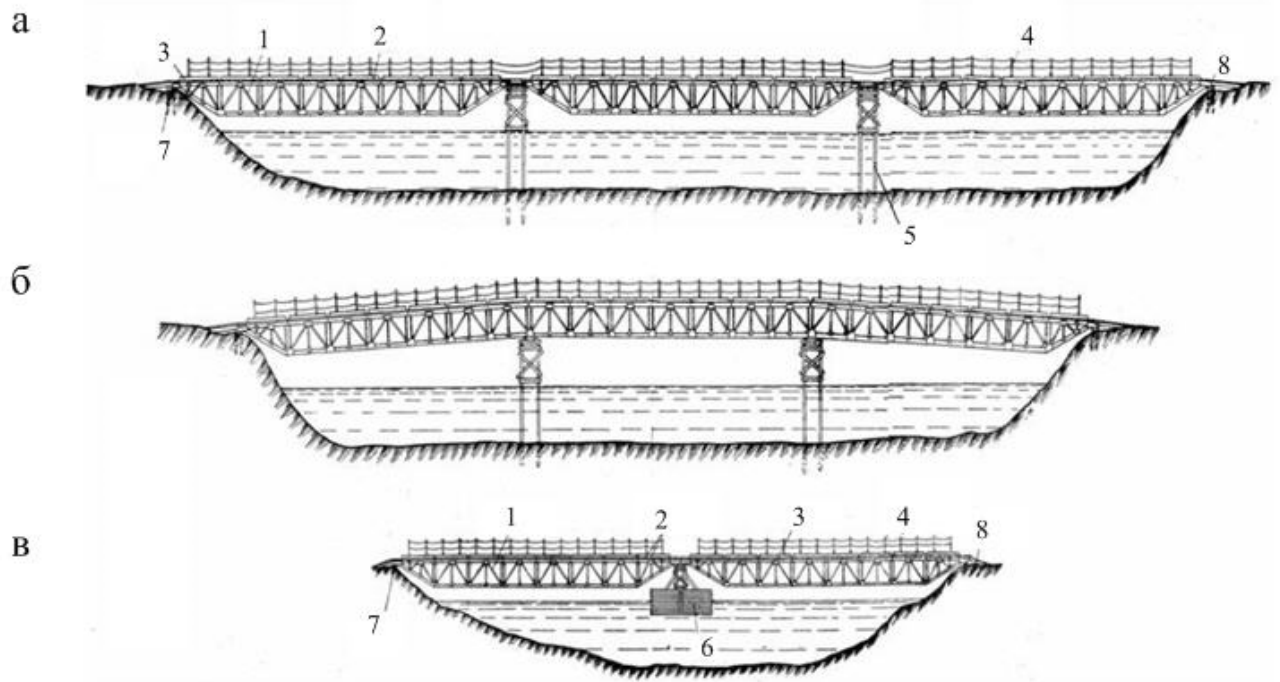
Схеми мосту із комплекту РММ-4: а, б – на жорстких опорах; в – на плавучих опорах: 1 – головні ферми; 2 – настилочні щити; 3 – колесобій; 4 – перильні стойки; 5 – проміжна опора; 6 – проміжна плавуча опора; 7 – береговий лежень; 8 - східні
